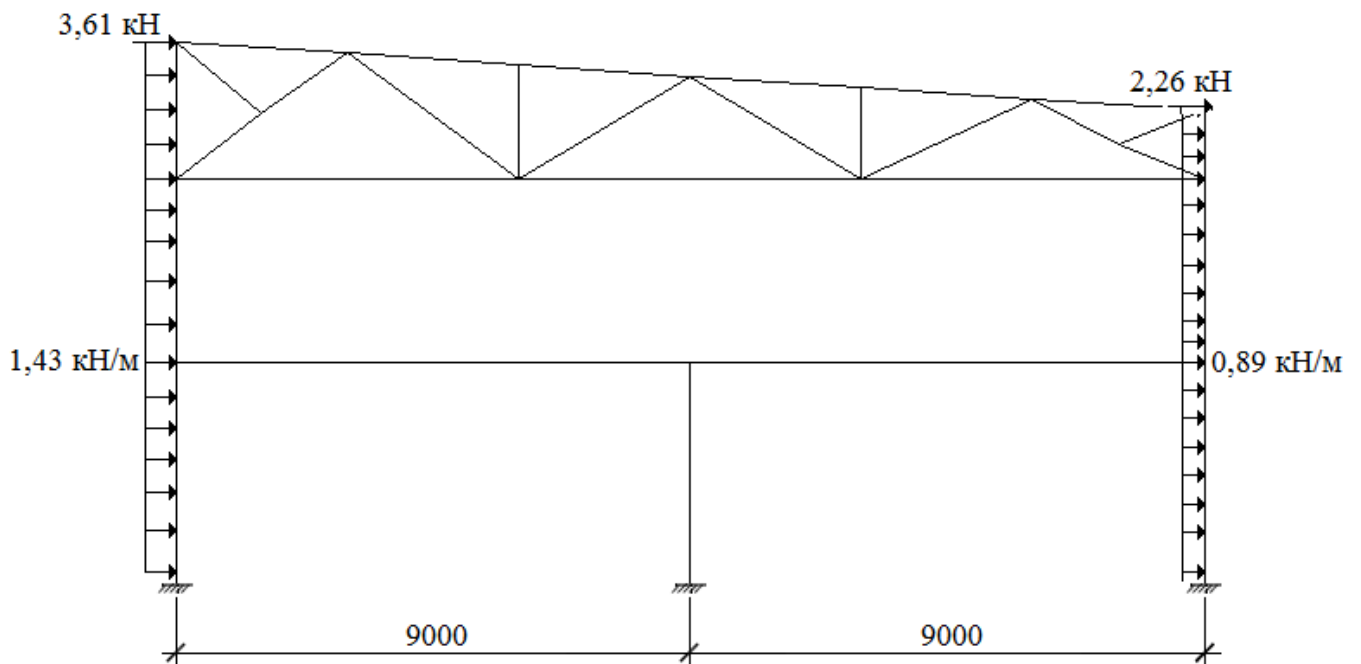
Схема загрузки от ветровой нагрузки слева здания
